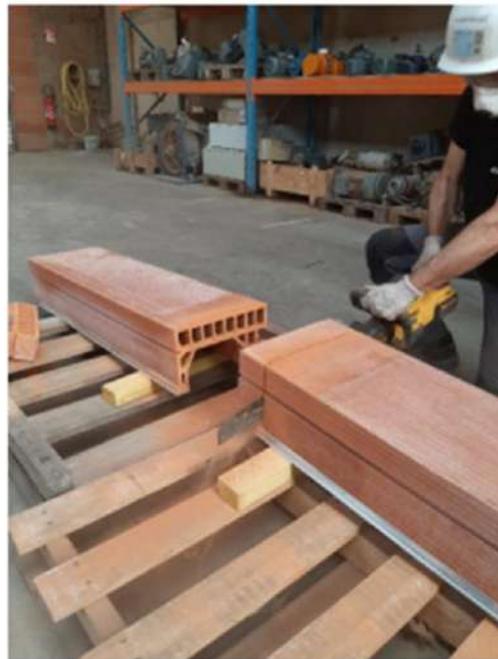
c : Traitement de la coupe avec Mortier joint mince
